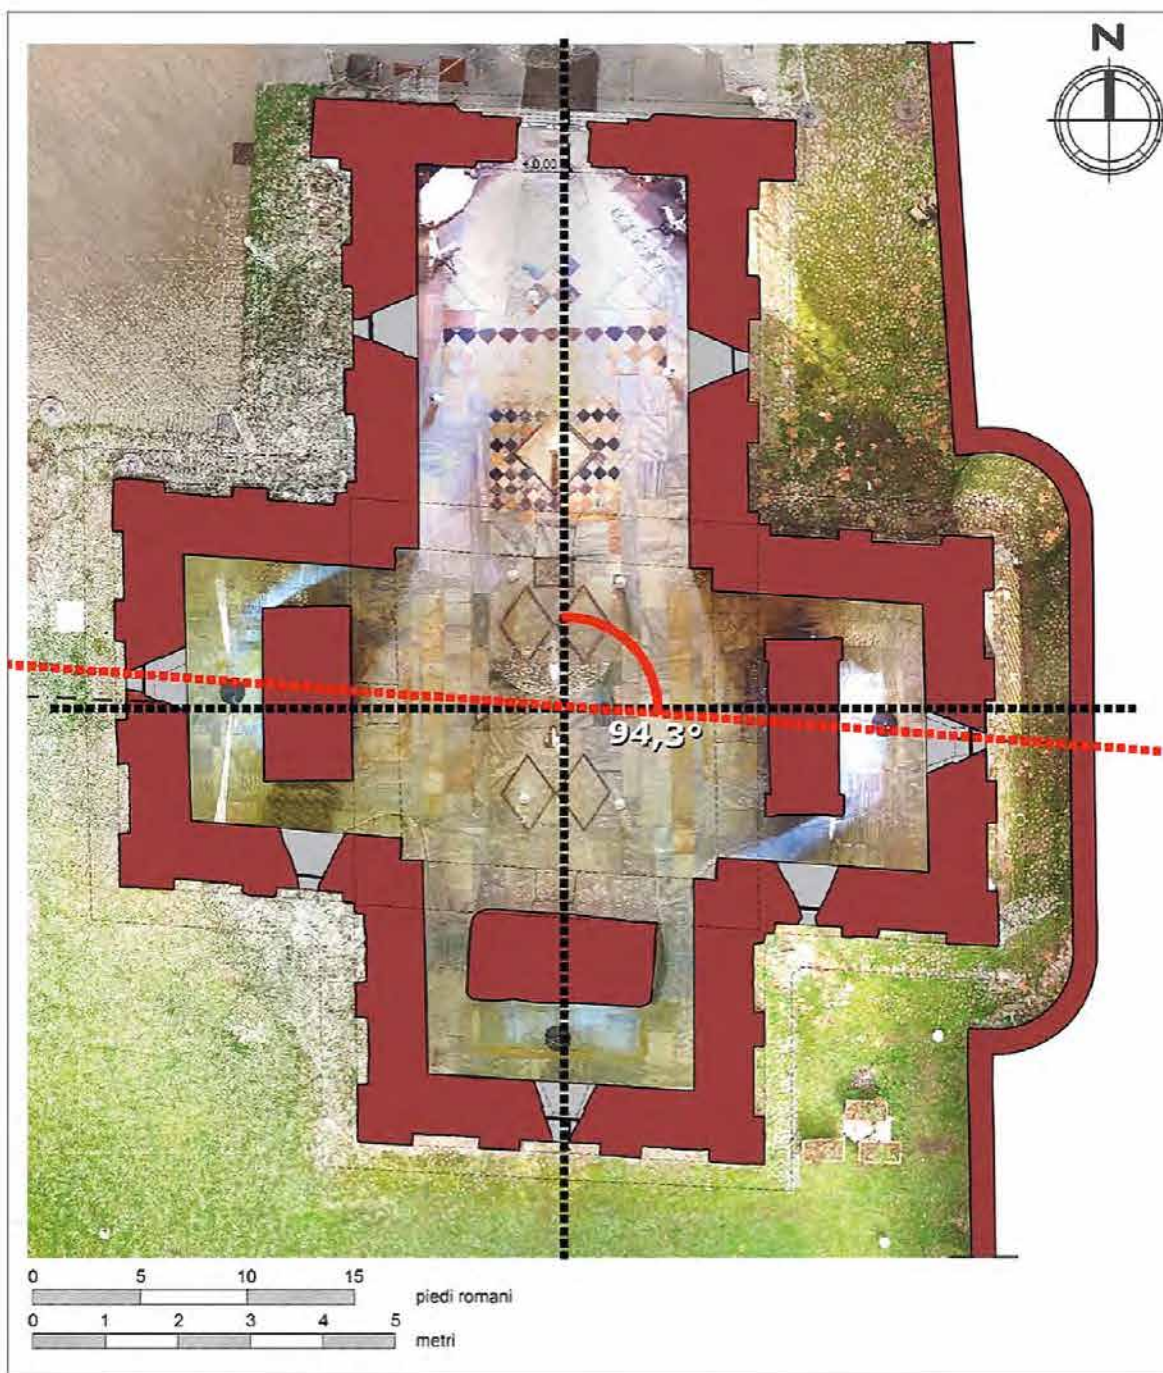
Pianta del Mausoleo di Galla Placidia (restituzione G. Lavoratti).
